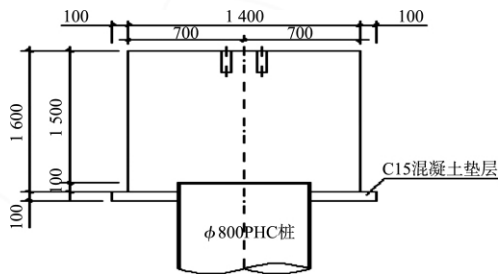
钢筋混凝土轨道梁断面 (单位: mm)
